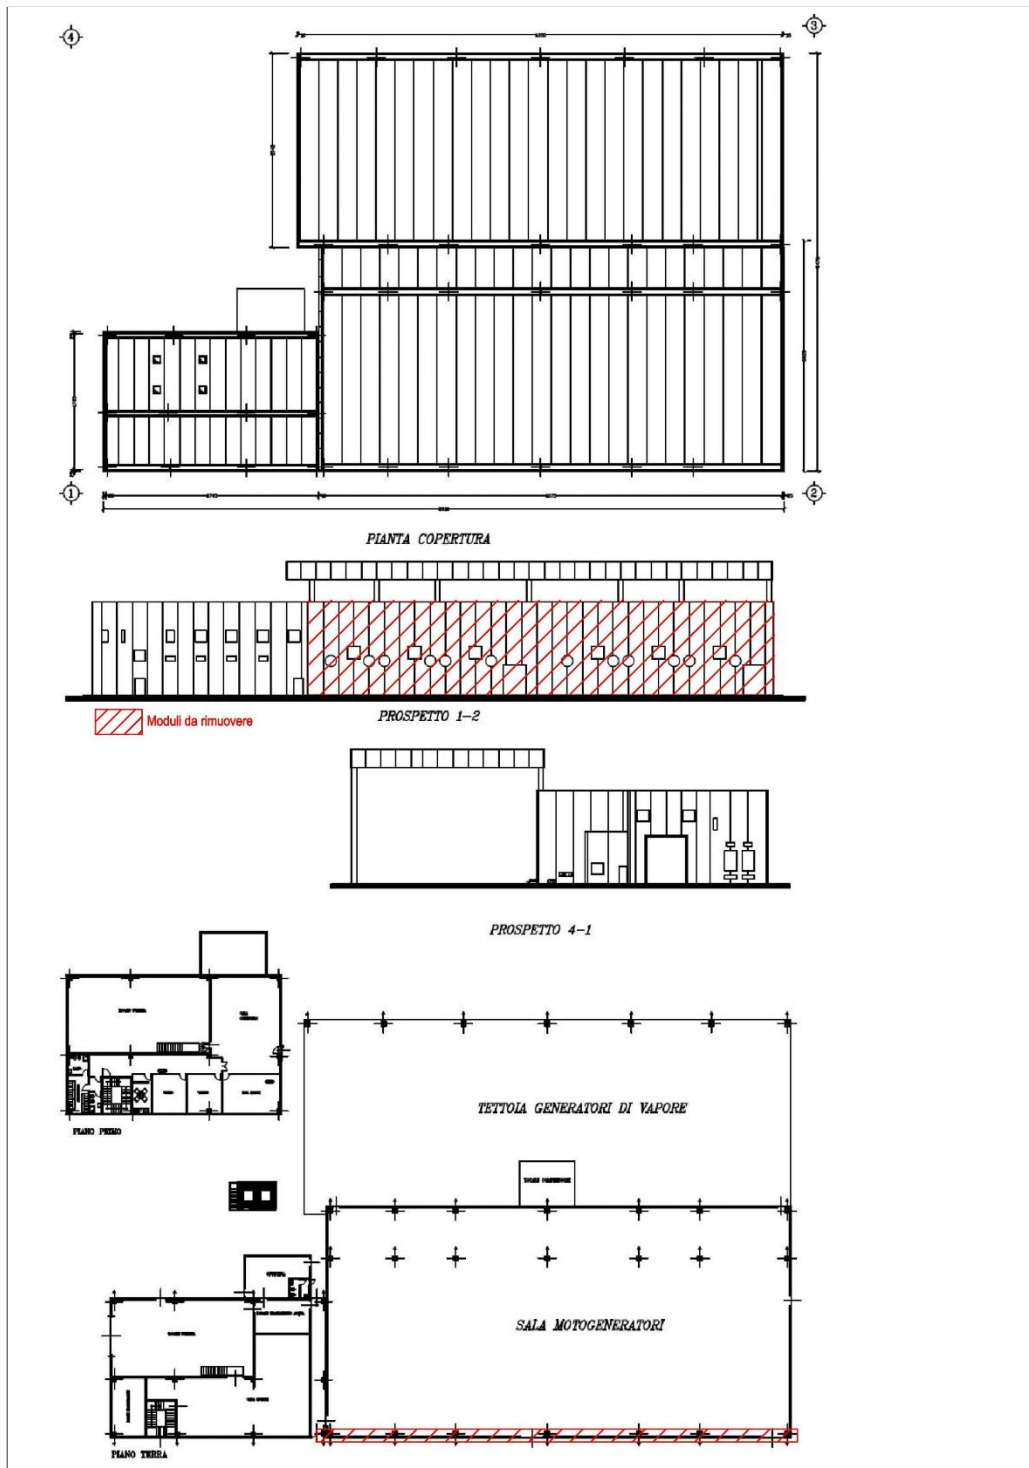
Pianta e sezioni dell'edificio in cui è installata l'impianto BL2
